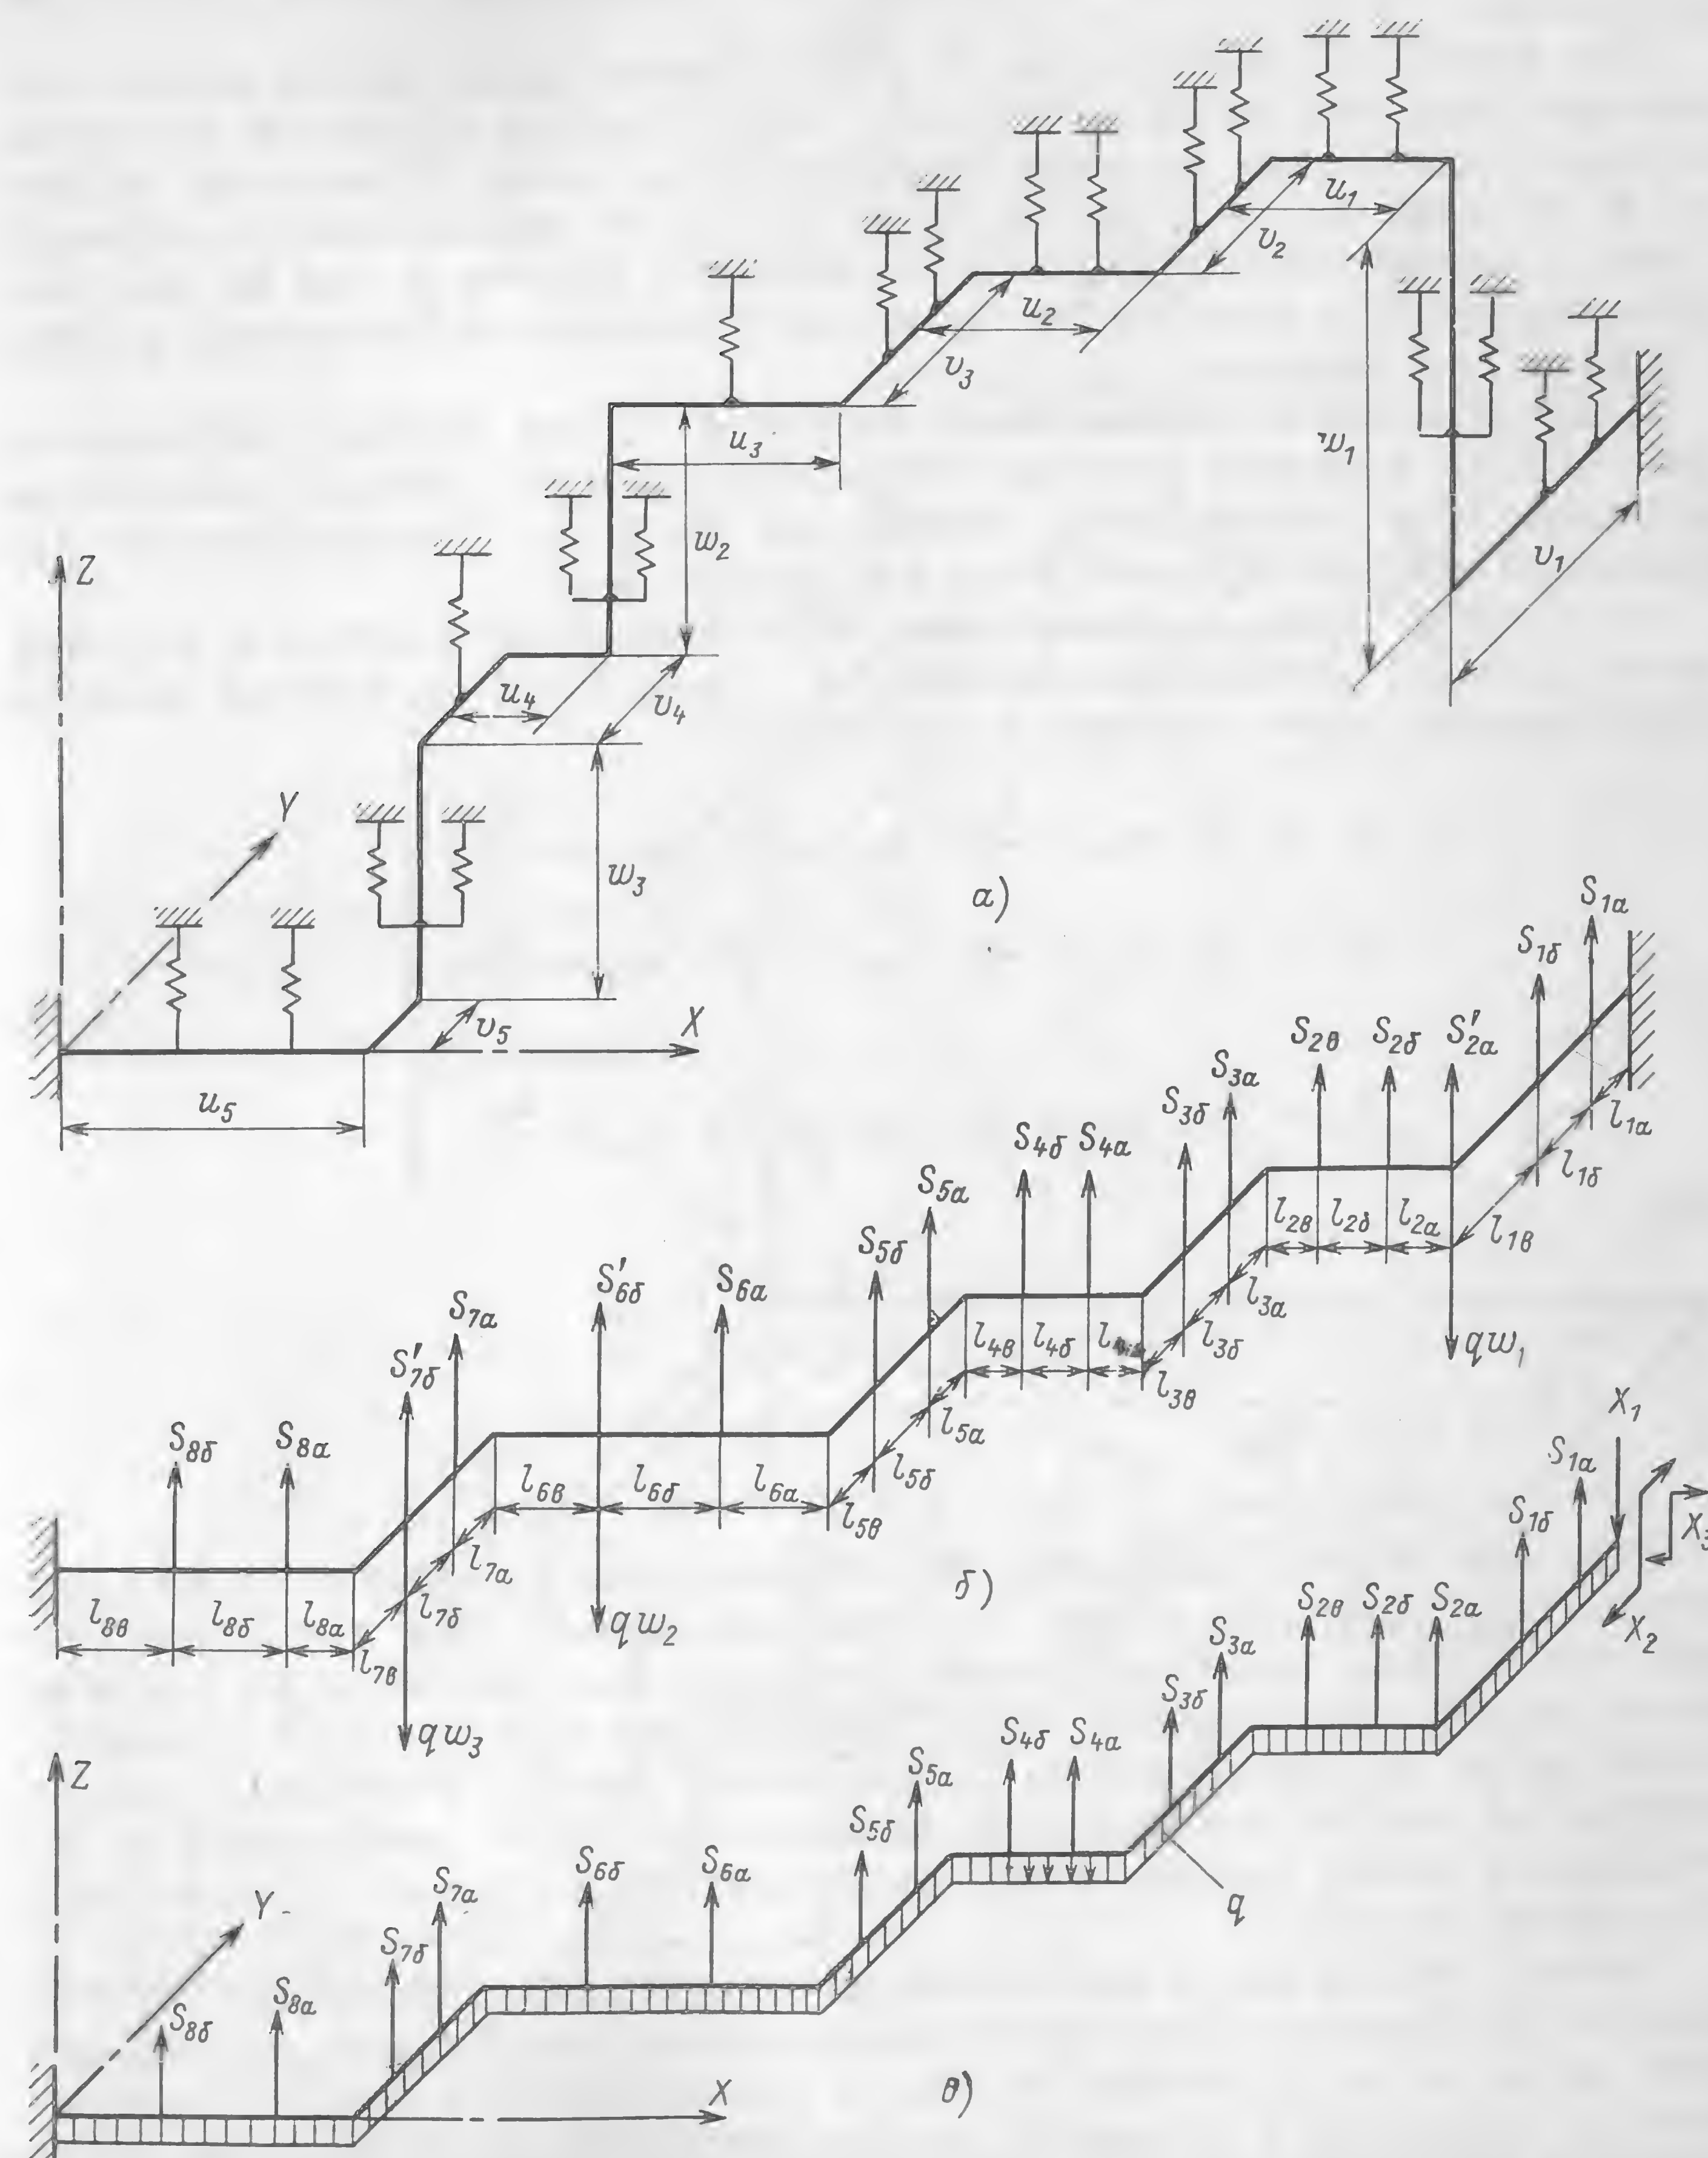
Преобразование реальной схемы пространственного неразветвленного трубопровода в расчетную схему для определения моментов от весовой нагрузки.
